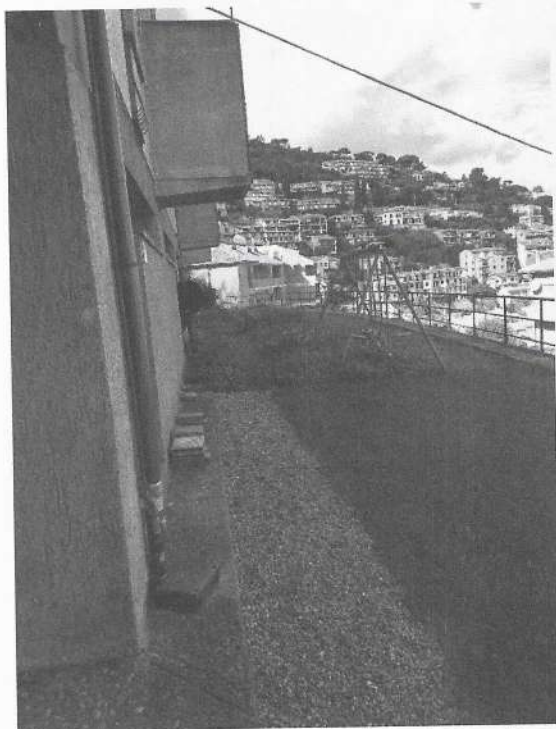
e 35: Vista esterna della corte comune al piano seminterrato dalla quale si accede al locale cantina e dell'ingresso alla cantina stessa.
